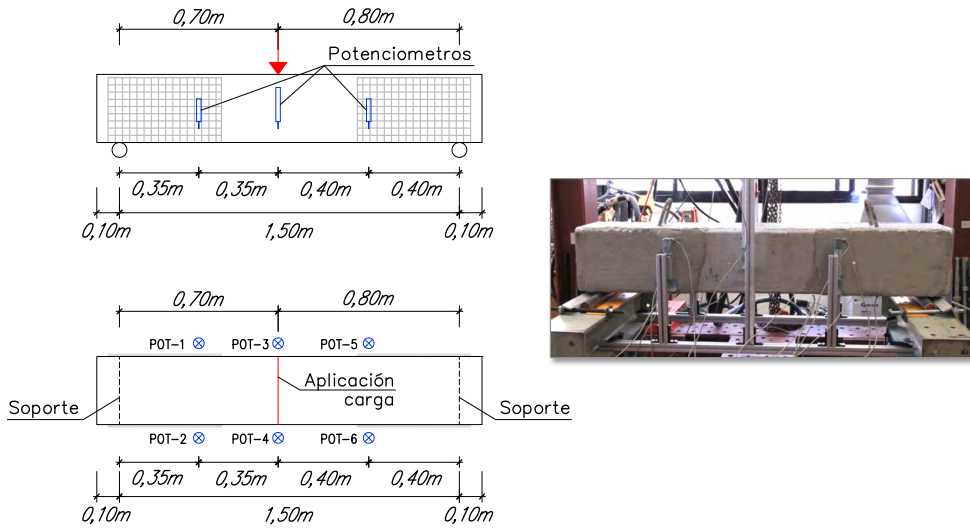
Configuración de ensayo: esquema del alzado y la planta (izquierda) se imagen real del montaje del ensayo (derecha).
